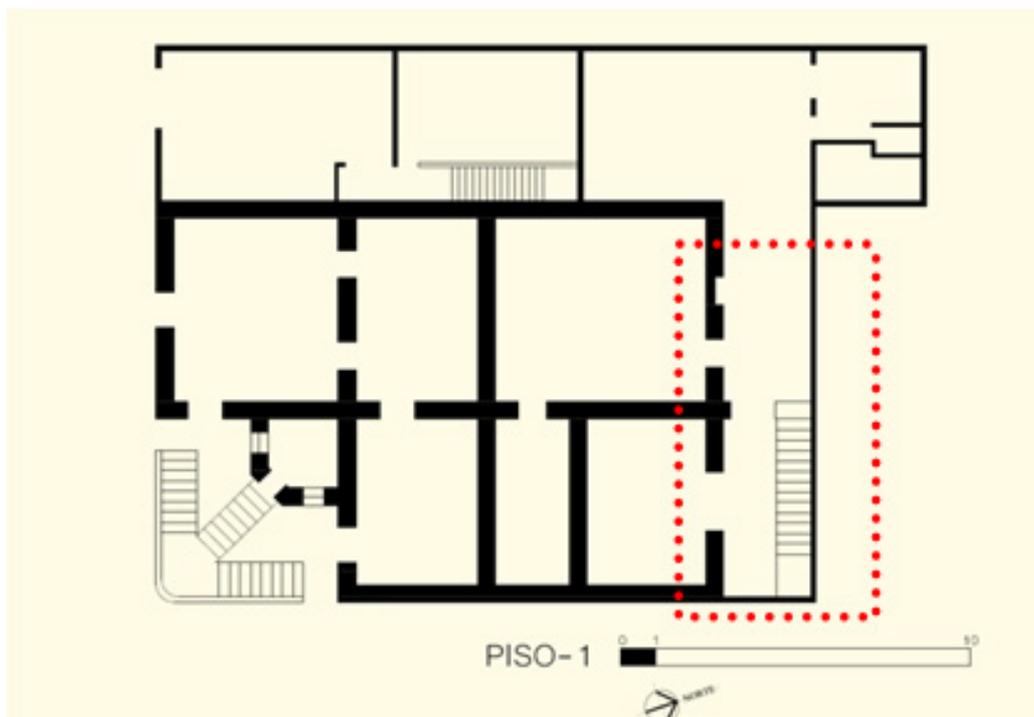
Antiga localização da escada no pavimento térreo. Fonte: levantamento realizado por DPJ em 2014-2017 e adaptado por Caroline M. F. Rodrigues e Ailla C. de C. Raiol, 2018.
